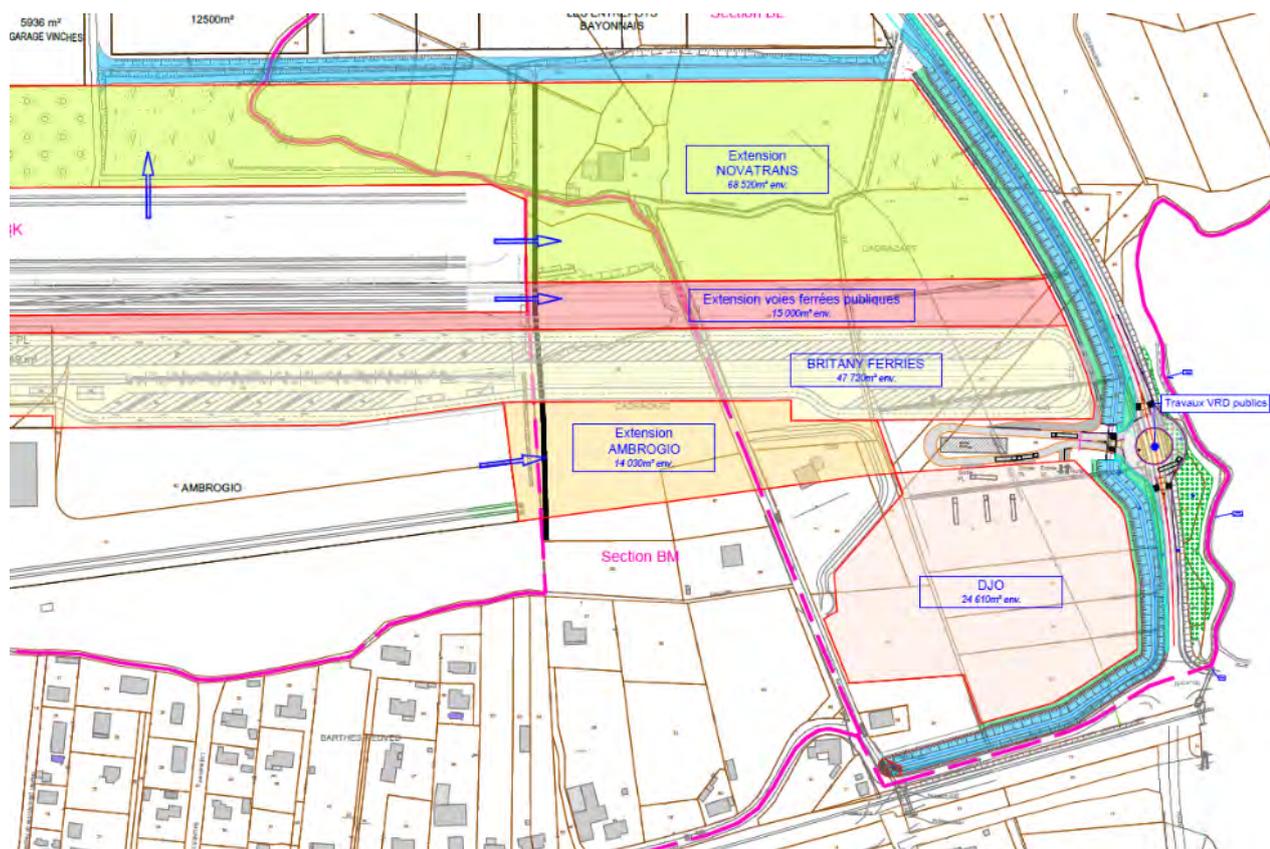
Plan masse du projet comprenant le projet DJO au sud et les extensions de terminaux ferroviaires au nord (Source : SEPA)
